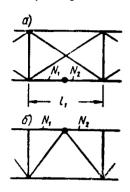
Схемы определепля ния расчетной длины элемента с различными усилиями  $N_1$  и  $N_2$  по его длине а -- схема связей между фермами (вид сверху); б — схема фермы
